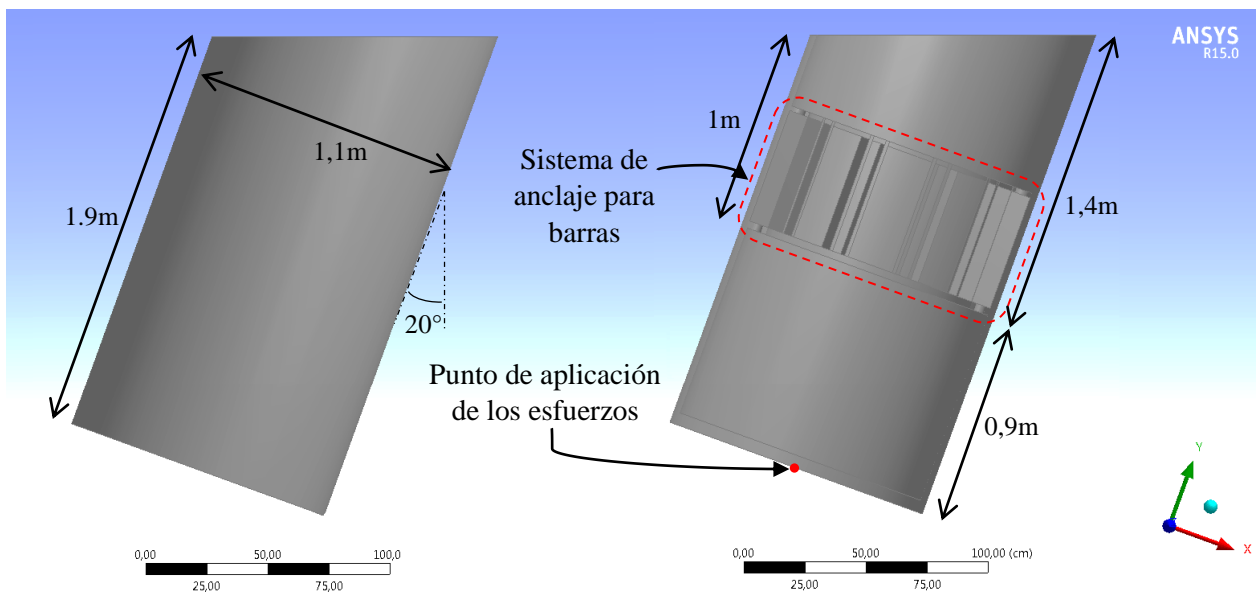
Vista exterior del pilote (izquierda) y vista interior del pilote (derecha).
